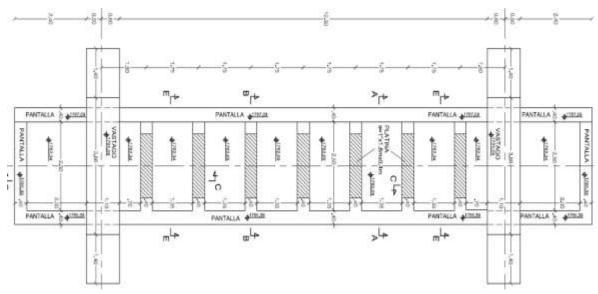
PLANTA DE CIMENTACION PILA CENTRAL
